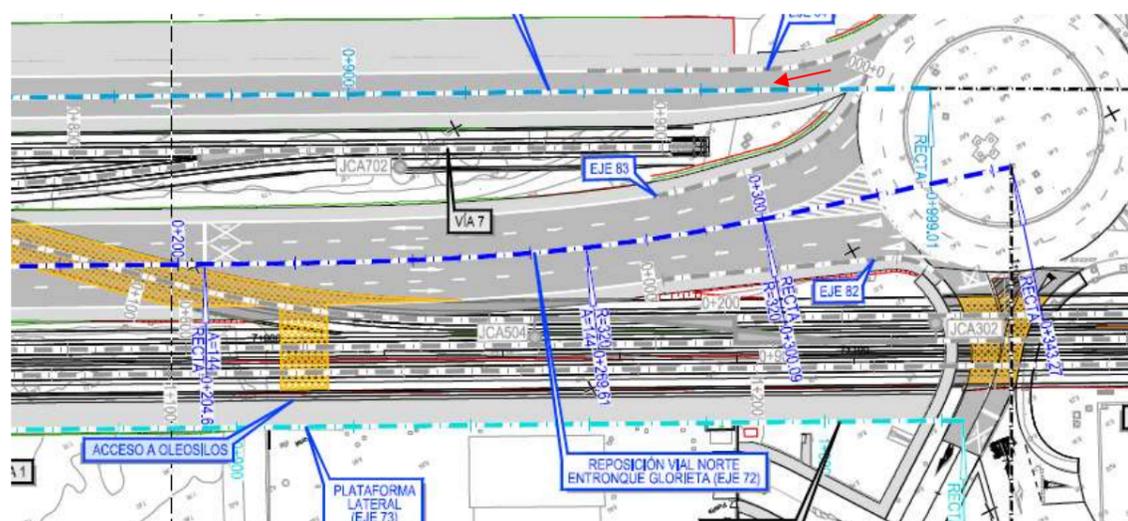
Planta general de la reposición del vial norte en el entronque con glorieta.
